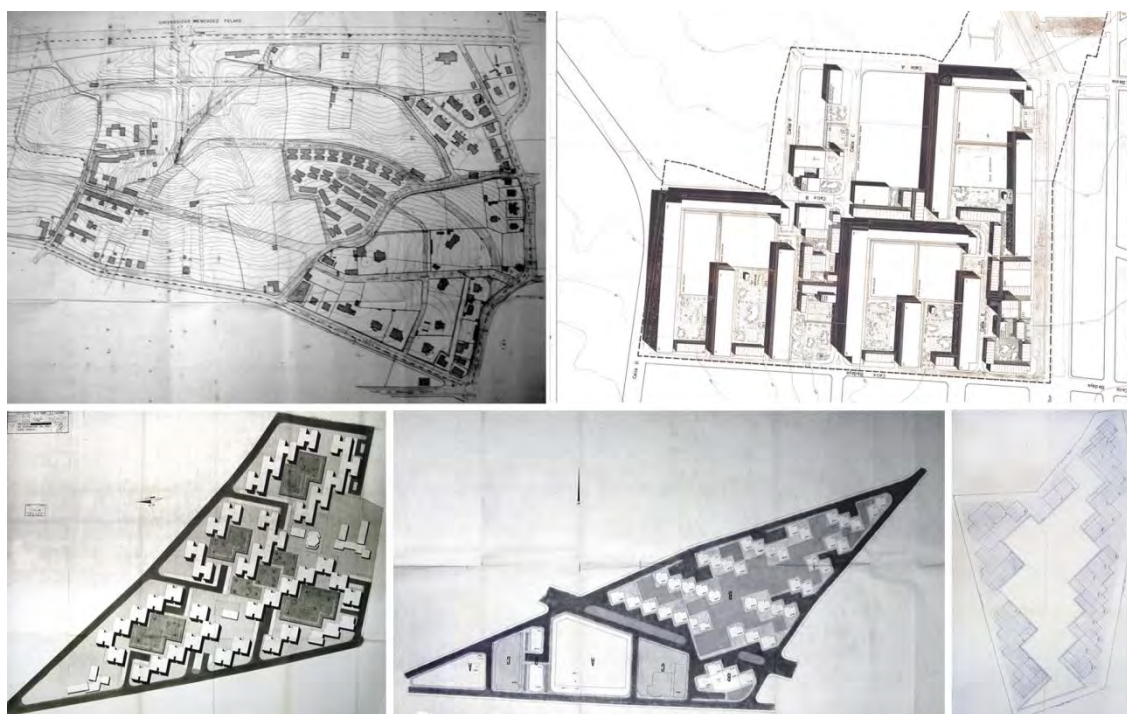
De arriba abajo y de izquierda a derecha, (a) Plano de Plan Parcial de la Gándara, 1965, incluyendo la preexistente Colonia Los Pinares en su parte central; (b) Plan Parcial Polígono 21 Txagorritxu, 1965; (c) Plan de Ordenación del Polígono 7 –Orvina 2; (d) Plan Parcial del Polígono 7 –Orvina 2, 1968; y (e) Estudio de Detalle Polígono 13, 1981. Fuentes: Ordeig-Corsini et al, 2011, 39; Archivo General Gobierno Vasco; Archivo Municipal de Pamplona; y Archivo de la Oficina Técnica del Ayuntamiento de Huesca, respectivamente.
